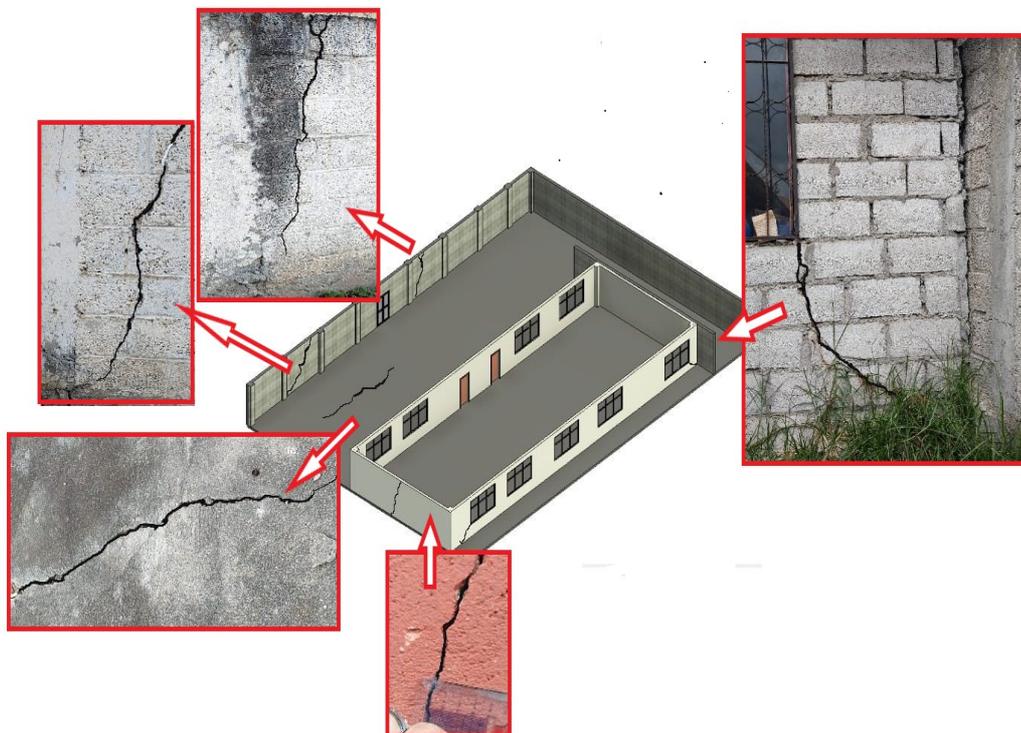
Casa 18. Detalle de fisuras en escuela esquematizada.
